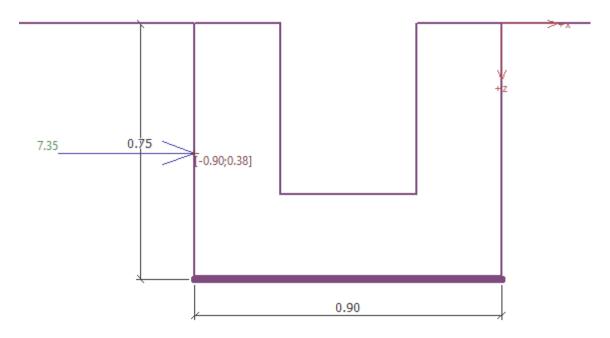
Presión idealizada de estructuras existentes aplicadas a la cuneta (1.00 ton/m²)
